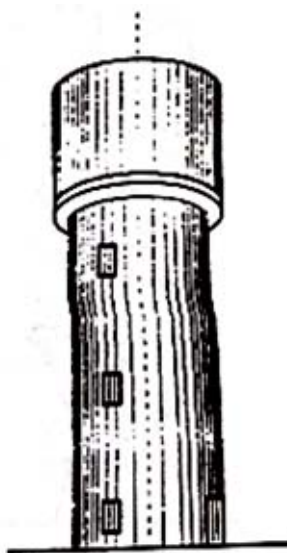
Tanque elevado de concreto con traves rigidizantes
